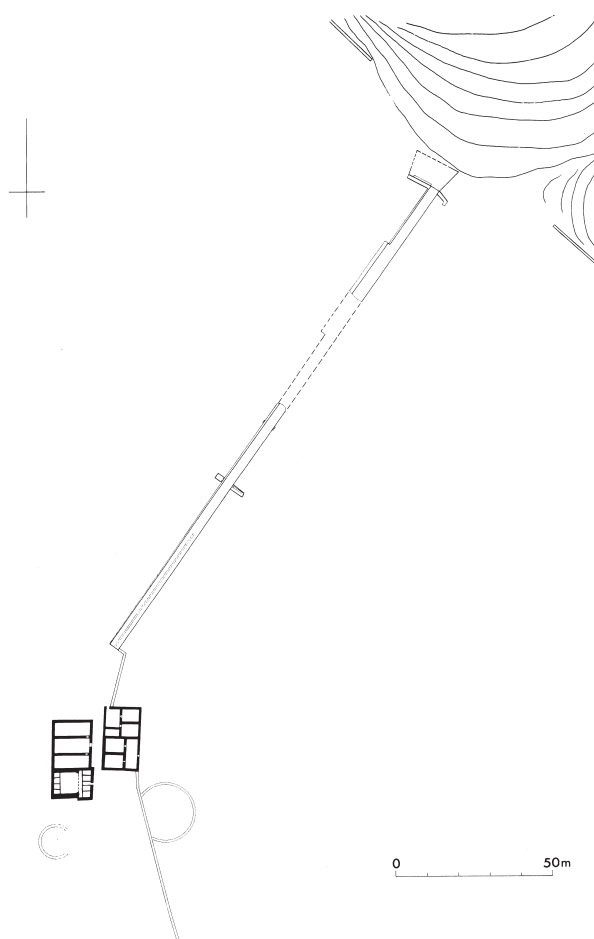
Umm al-Walid/Wadi al-Qanatir : plan du barrage aval et des installations voisines (dessin Wilfried Trillen).
